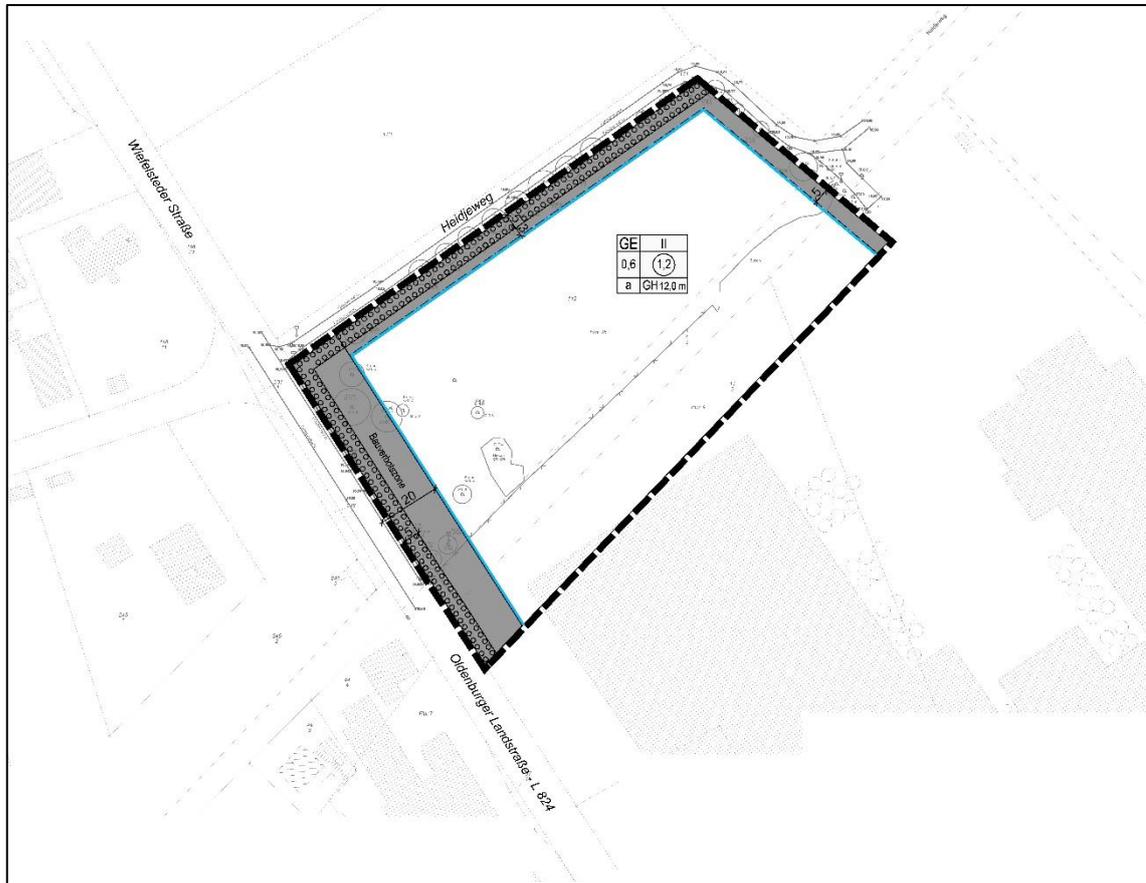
Vorentwurf der Planzeichnung zum Bebauungsplan Nr. 73 IV /7/
